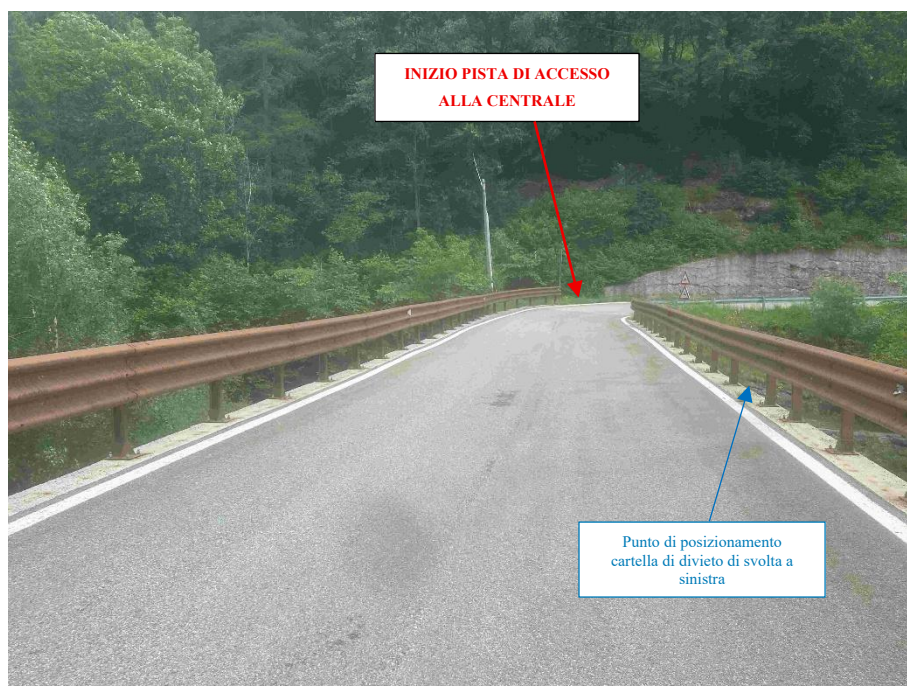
Vista del ponte di Salzetto della S.P. 48 direzione Piamprato; si prevede la posa di cartello di divieto di svolta a sinistra al fine di vietare accesso alla pista provenendo da Valprato
